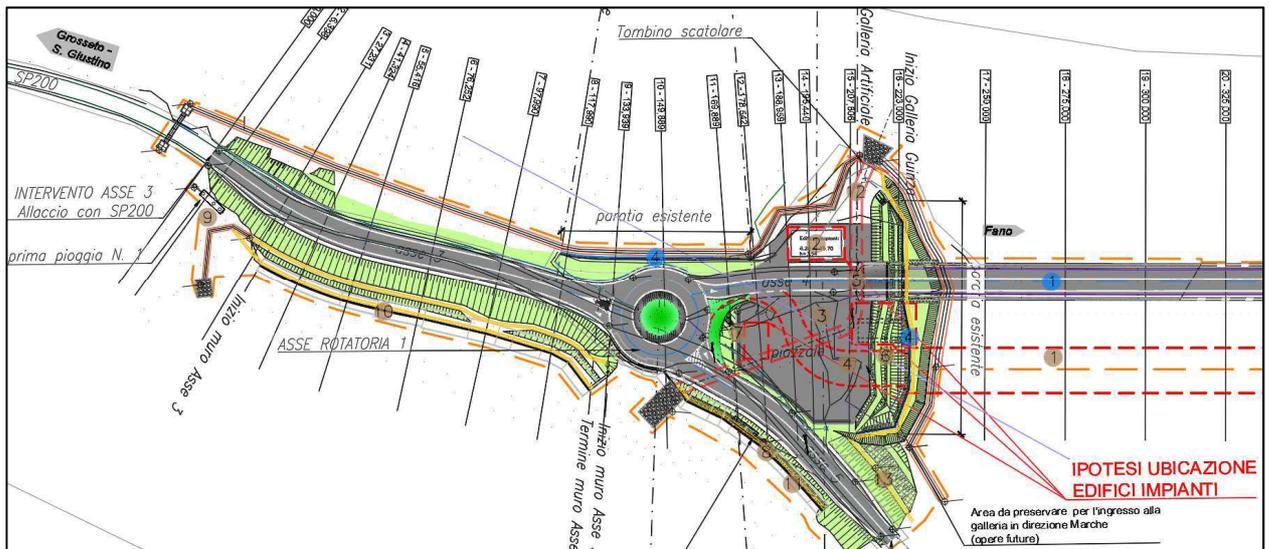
Planimetria dell’intersezione sul lato umbro della Galleria della Guinza (Rotatoria 1)
